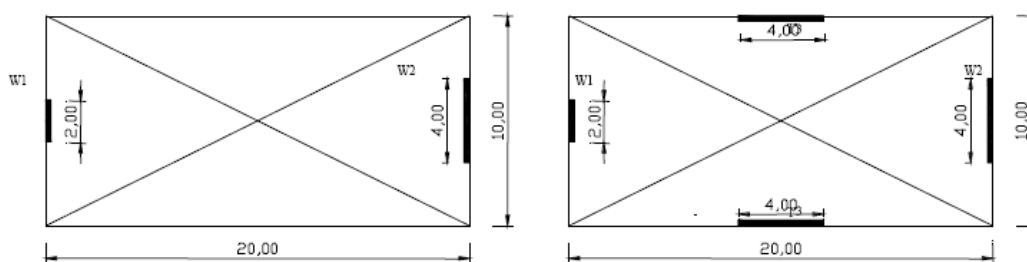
Strutture studiate ad un solo piano: la prima ha due elementi irrigidenti mentre la seconda, rispetto alla prima, ha due elementi irrigidenti in più.
